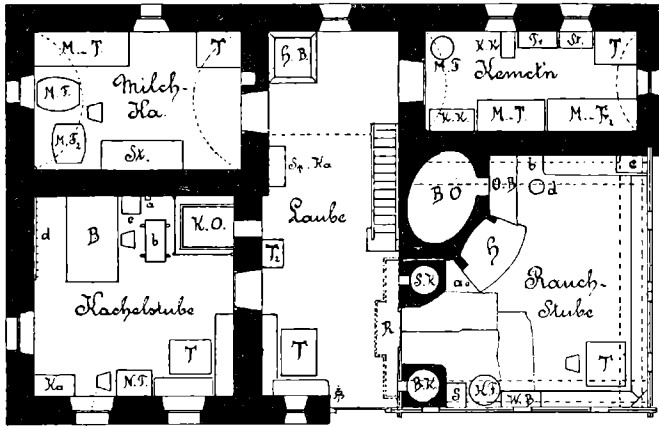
Grundriss des Erdgeschosses des Jank-Hauses.
